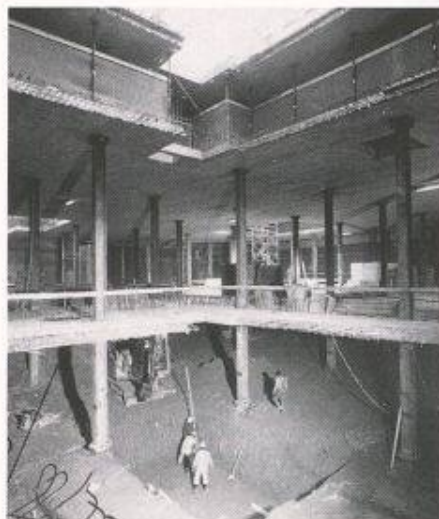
Die Untergeschosse werden in Deckelbauweise erstellt
